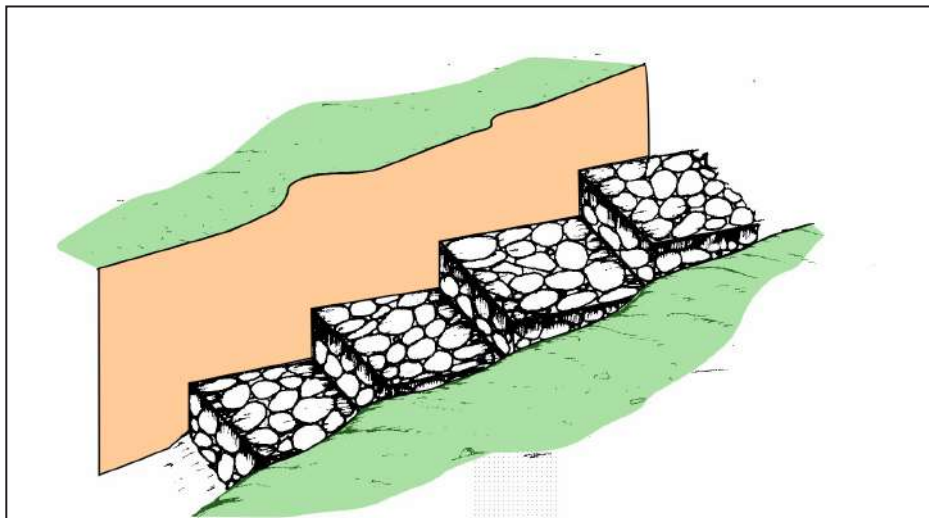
Protección del lecho de la quebrada con muros escalonados (andenes), utilizando bloques de roca o concreto armado.
